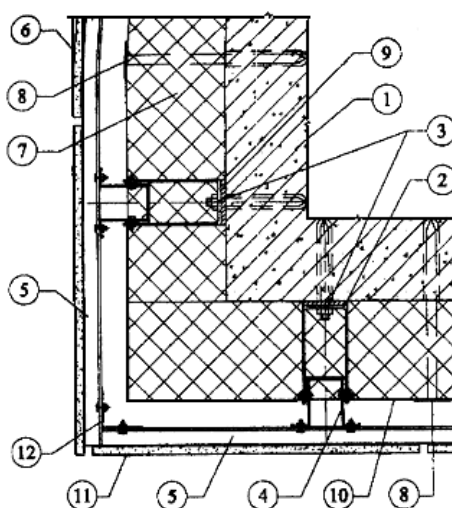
Вентилируемый фасад (горизонтальный разрез):
